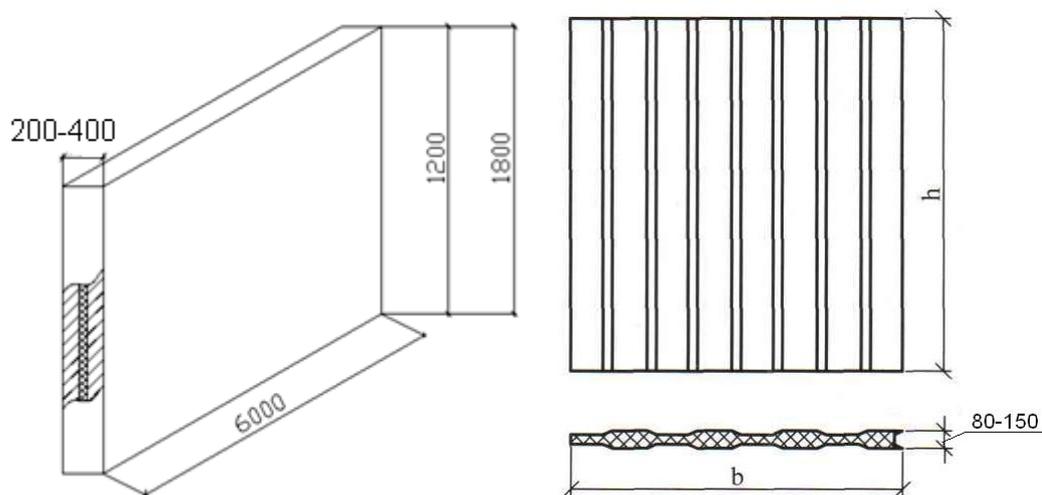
Стеновые панели: железобетонные и типа «сэндвич»
